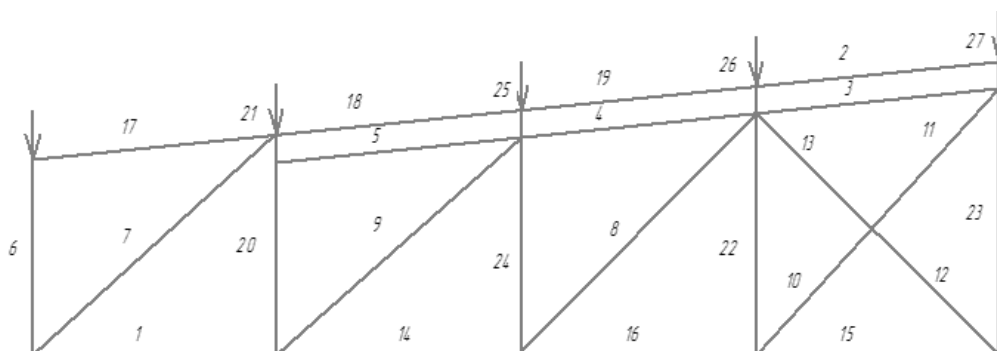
Расчетная схема половины фермы до реконструкции (указаны номера стержней).
